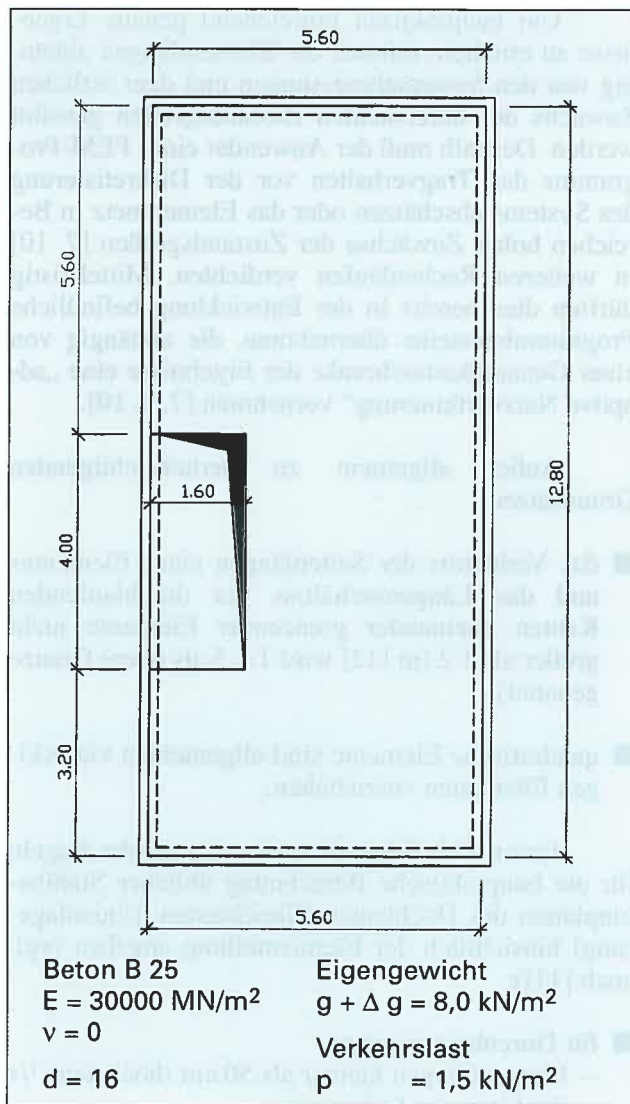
Deckenplatte eines Reihenhauses – Abmessungen und Belastung
